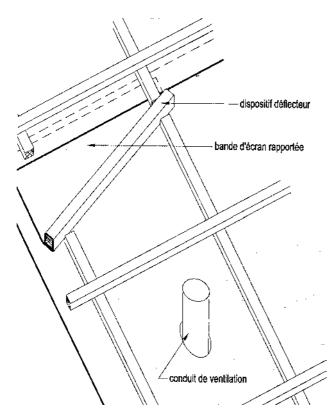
Sortie de conduit de ventilation (raccord avec dispositif déflecteur)
